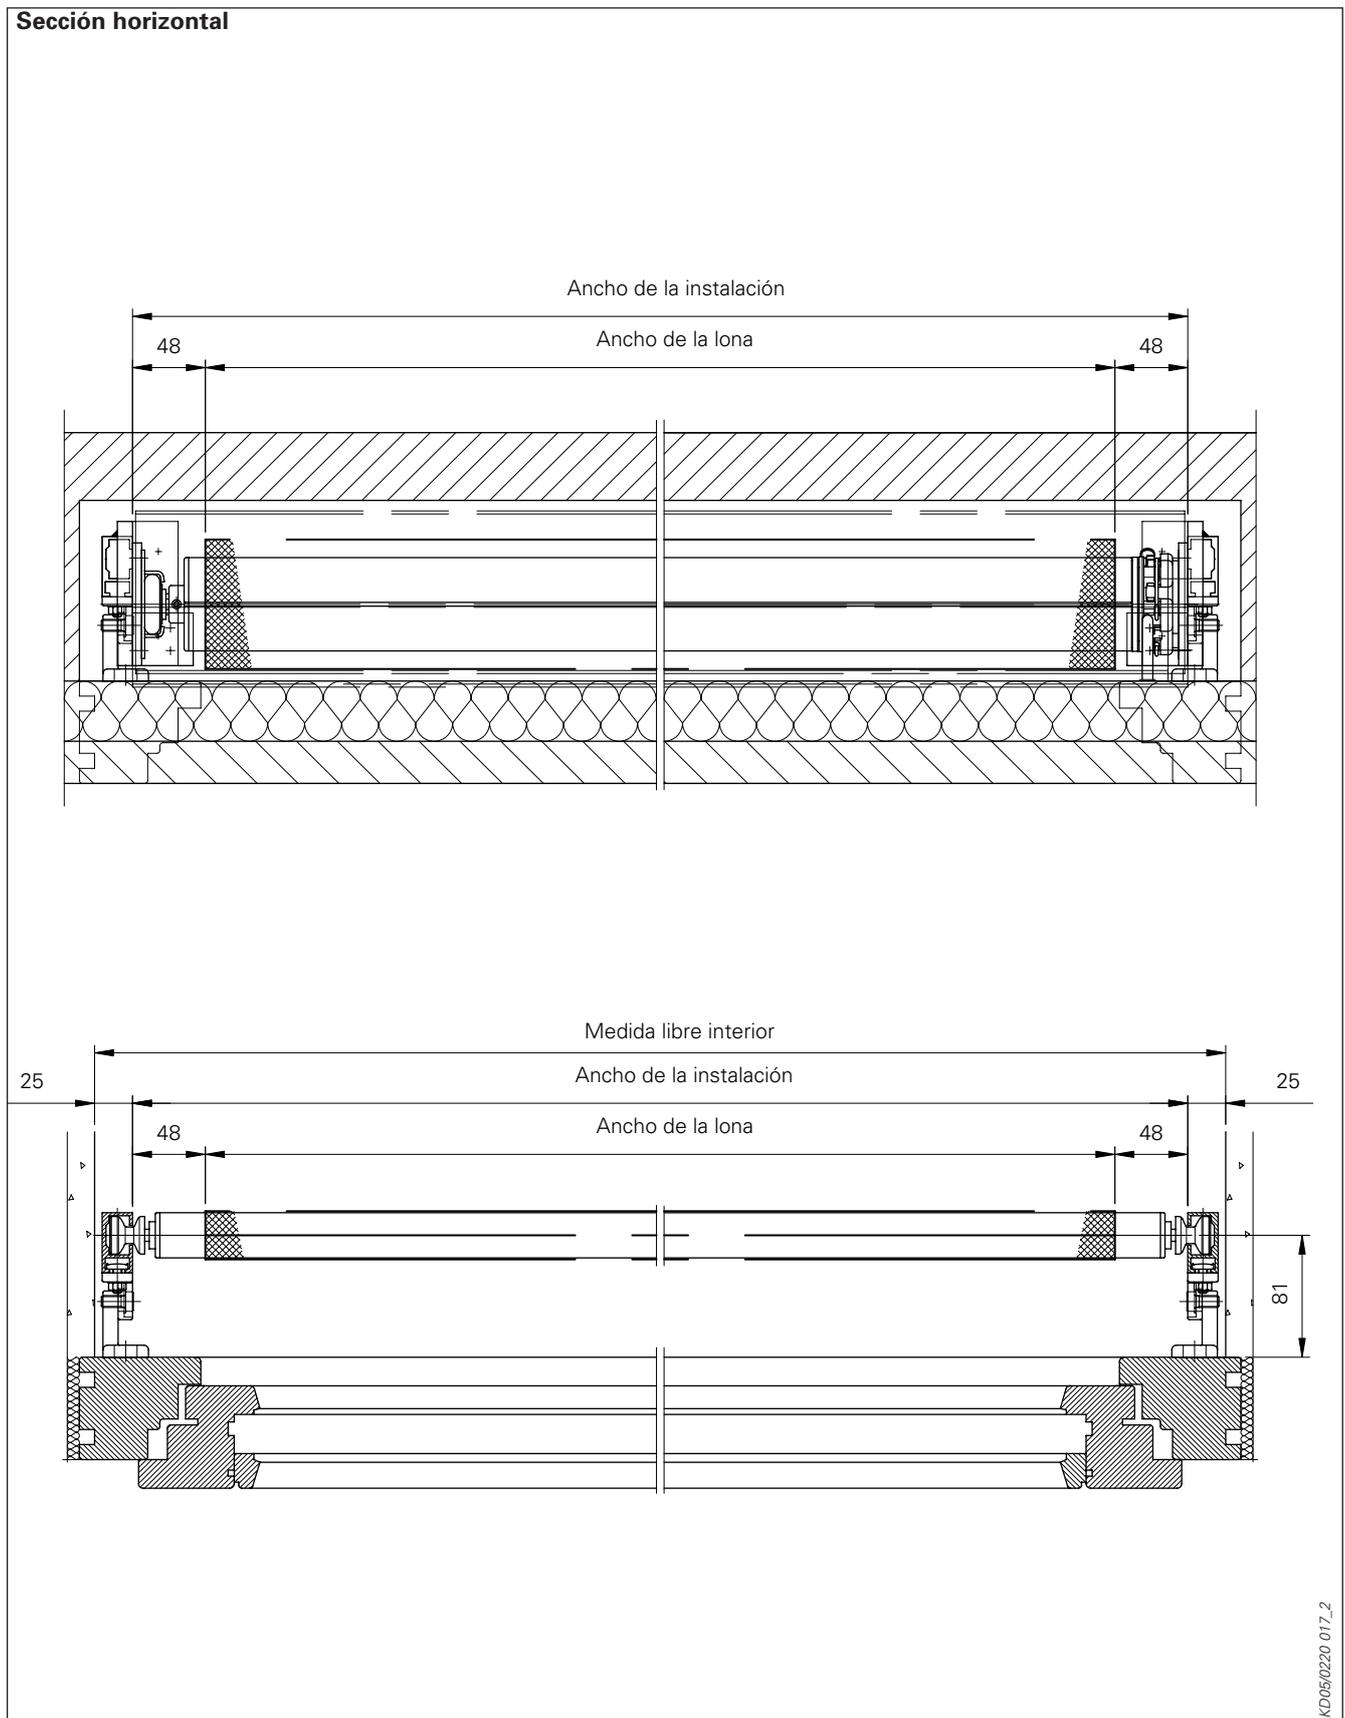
Sección horizontal toldo para fachada Modelo 209 E con carril en C 20/40 en hueco in situ
